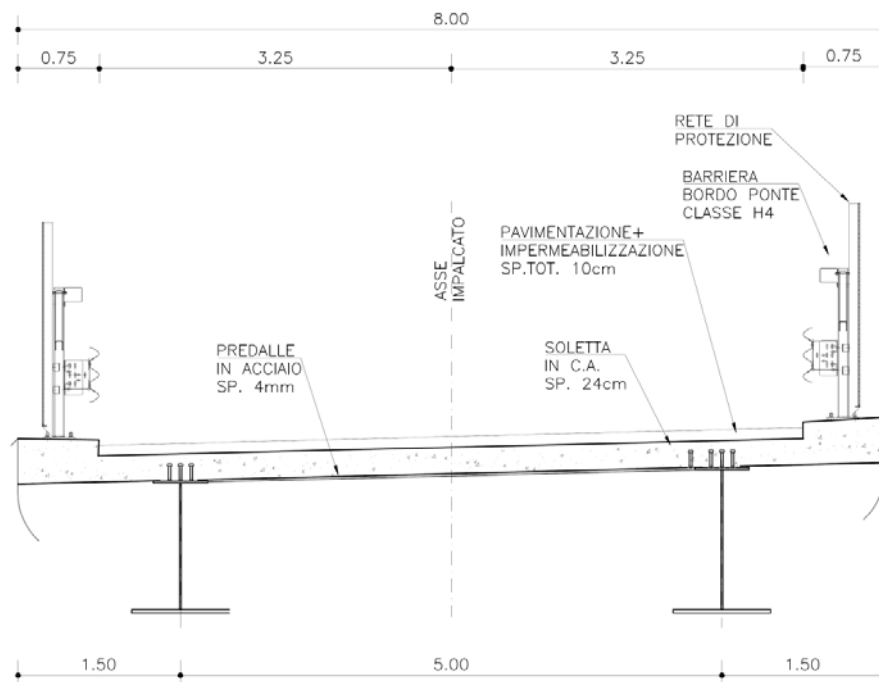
Sezione trasversale dell'impalcato nel tratto di larghezza 8.00 m
